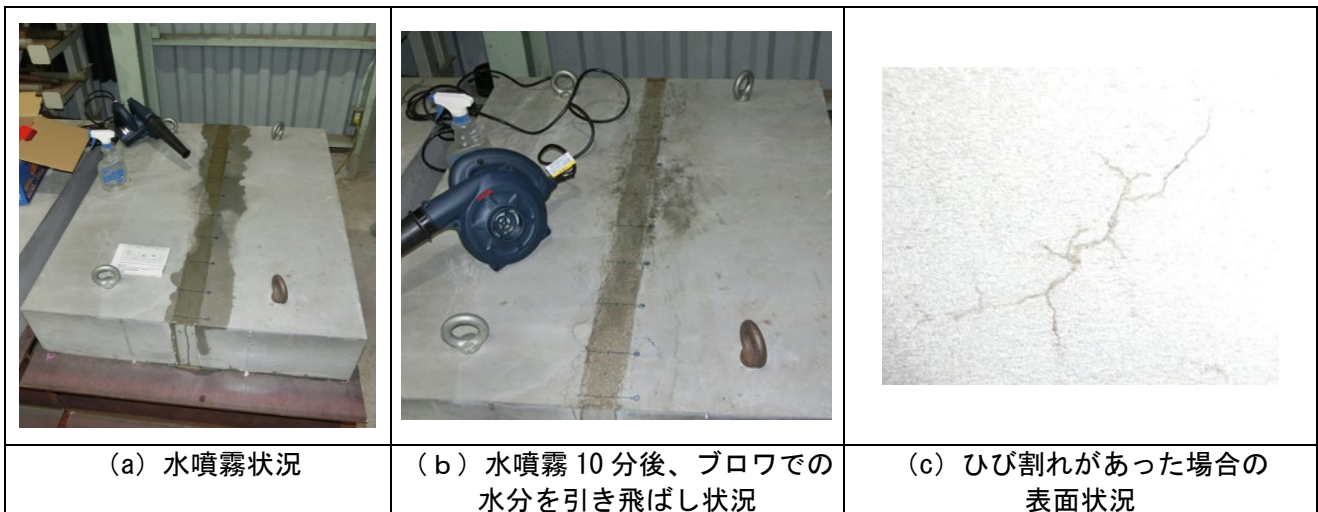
水噴霧によるひび割れ発生有無の確認
